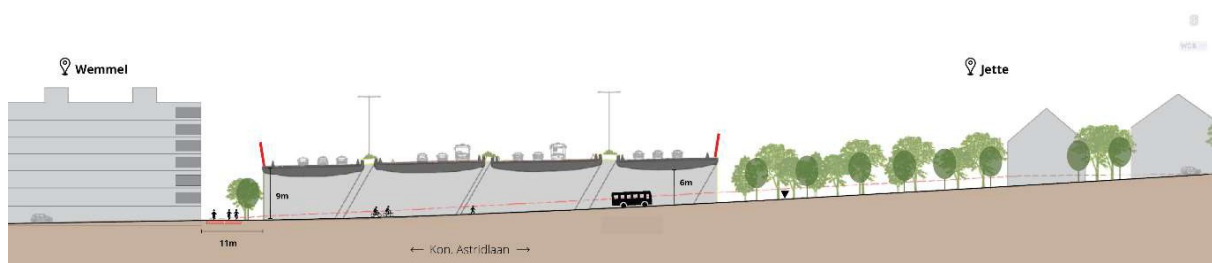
Coupe G2A1 - Profil longitudinal optimisé - Avenue R. Astrid
